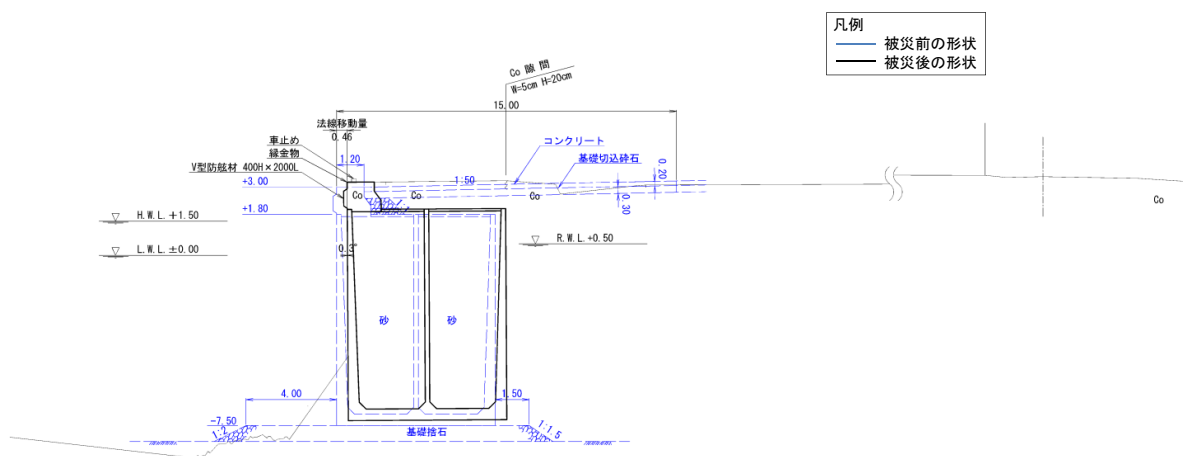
No.2 日立港区\_第1ふ頭地区1-B岸壁 (-7.5m) の断面図 (被災前・後)
